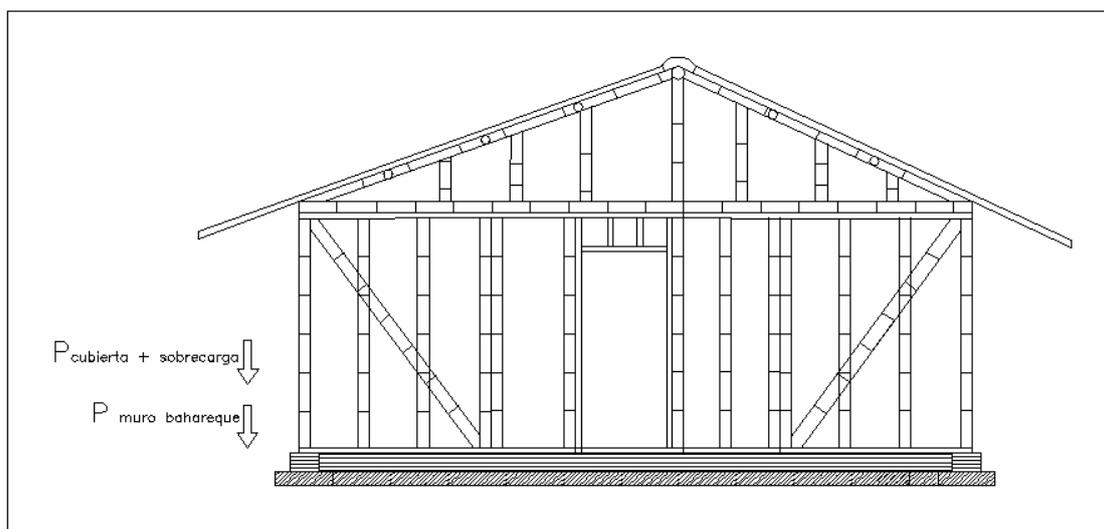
Cargas sobre zapata corrida para vivienda con estructura de caña y madera
